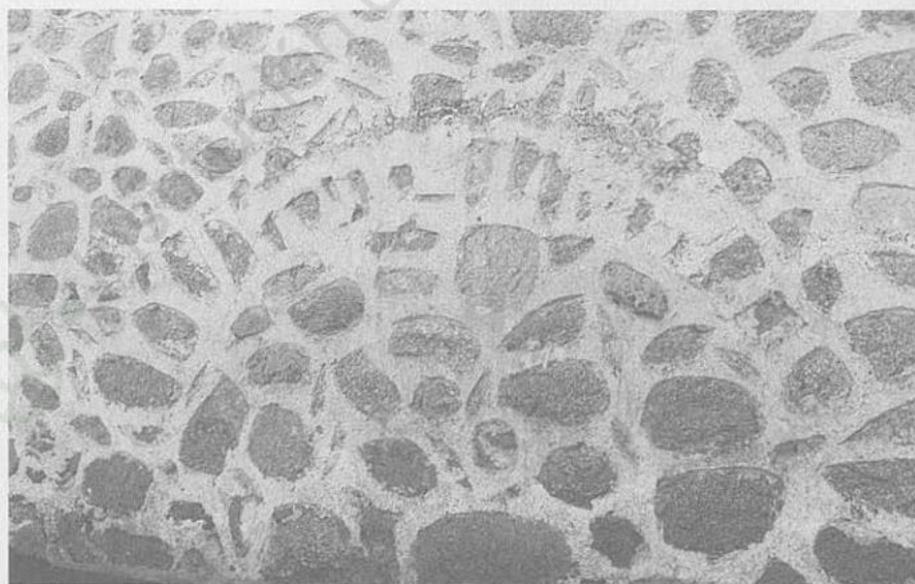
Claustro de los Reyes. Panda norte. Fachada norte. Basamento. Vano 4.
